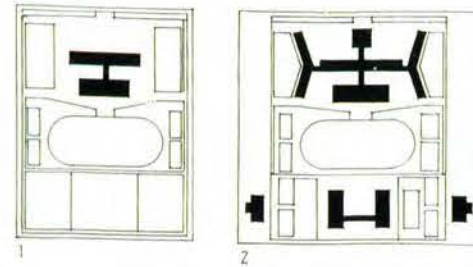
Versorgungsblock einer Wohngruppe für 2000 Einwohner. Architekt: N. Afanasjewa. 1962. Fassaden, Grundrisse
